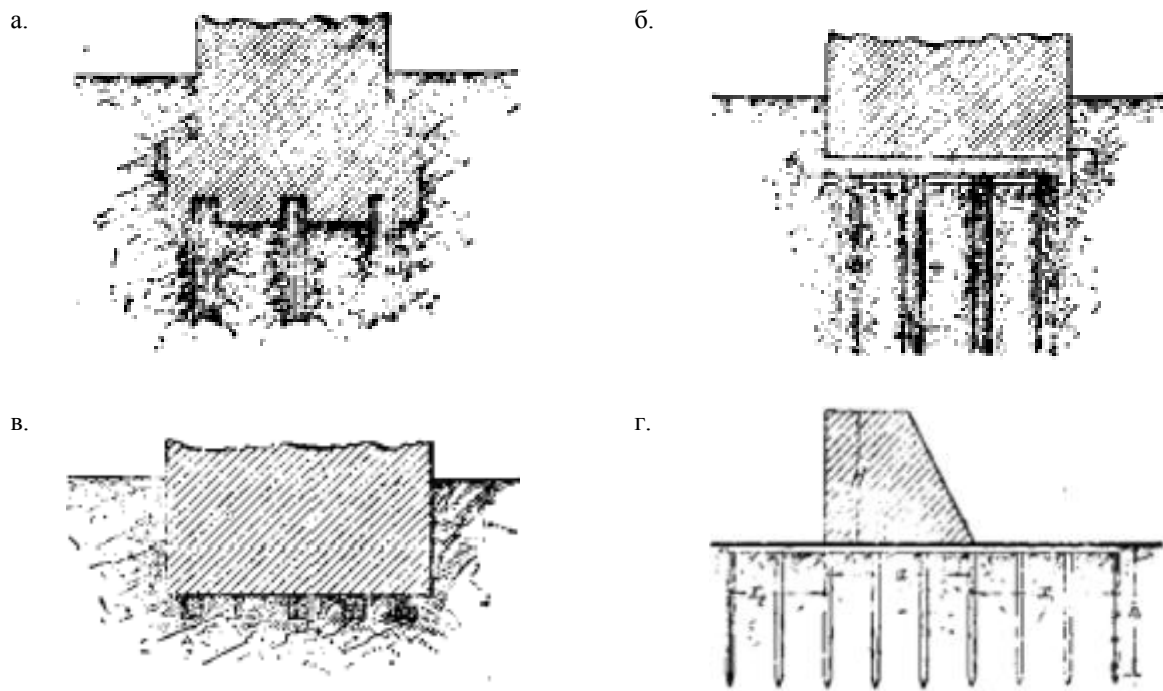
Конструктивные решения оснований фундаментов с использованием деревянных свай и лежней (фото из книги [6])
